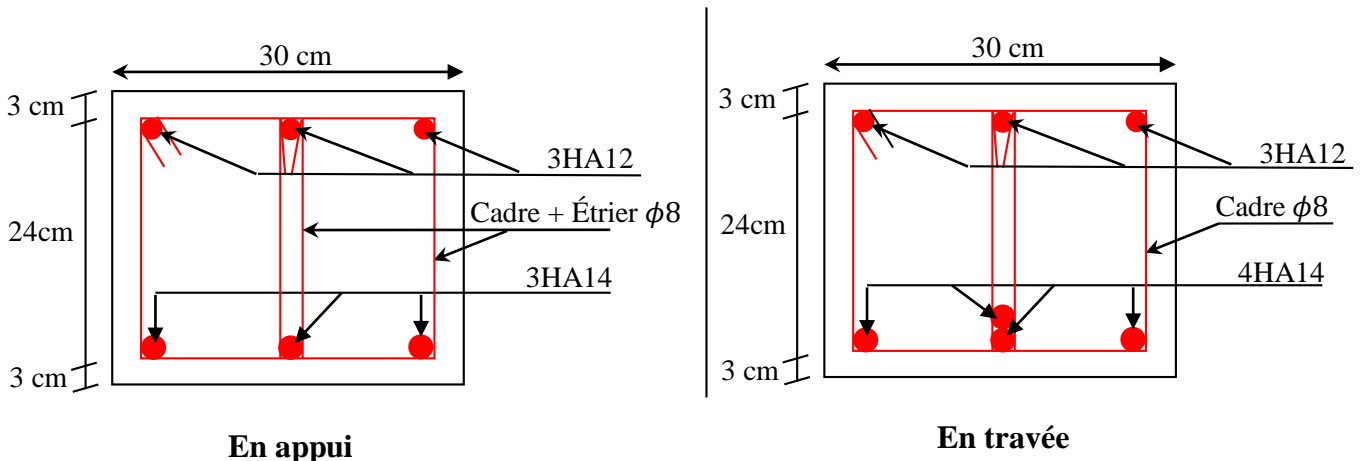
Schéma de ferrailage de la poutre de chaînage
